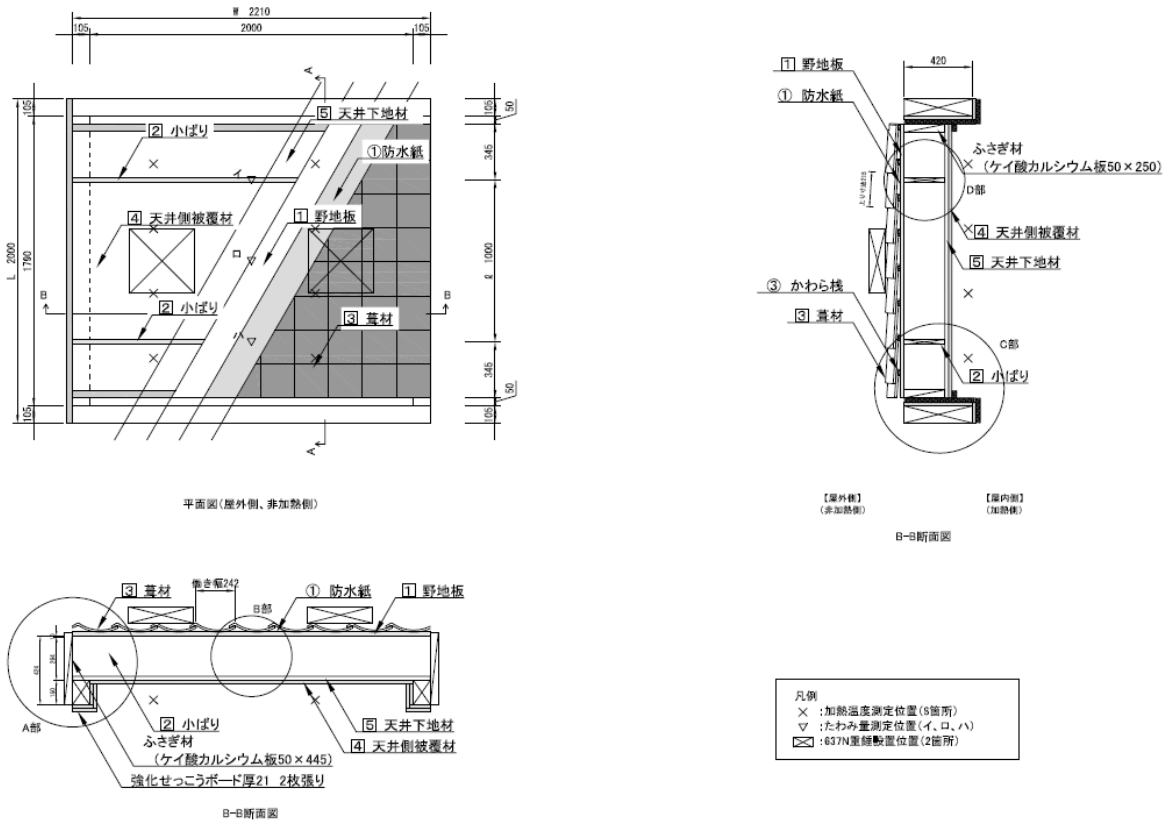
試験体の構造・寸法・温度測定位置(寸法単位:mm)
